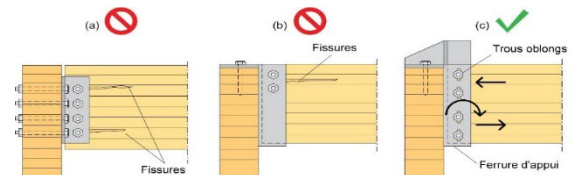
Liaison poteau et poutre primaire (handbook s.d.)
